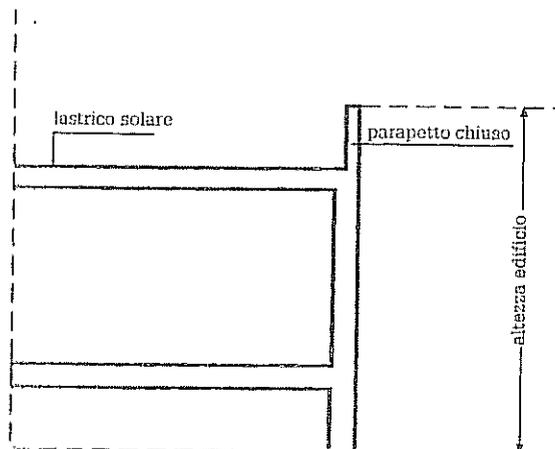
Edificio con copertura piana, parapetto chiuso e lastrico solare
